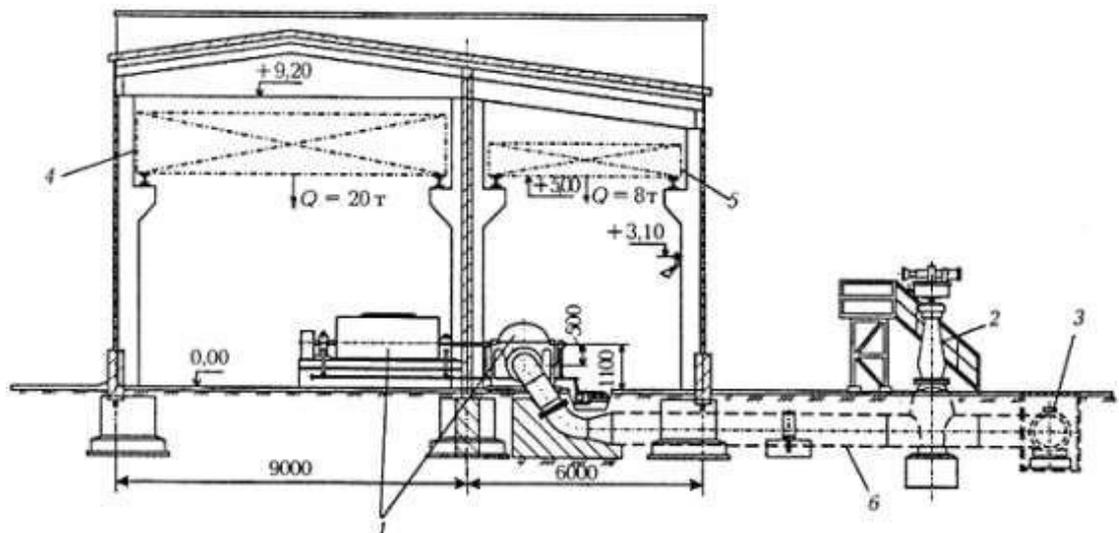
Насосний цех, обладнаний насосними агрегатами НМ3600-230:
